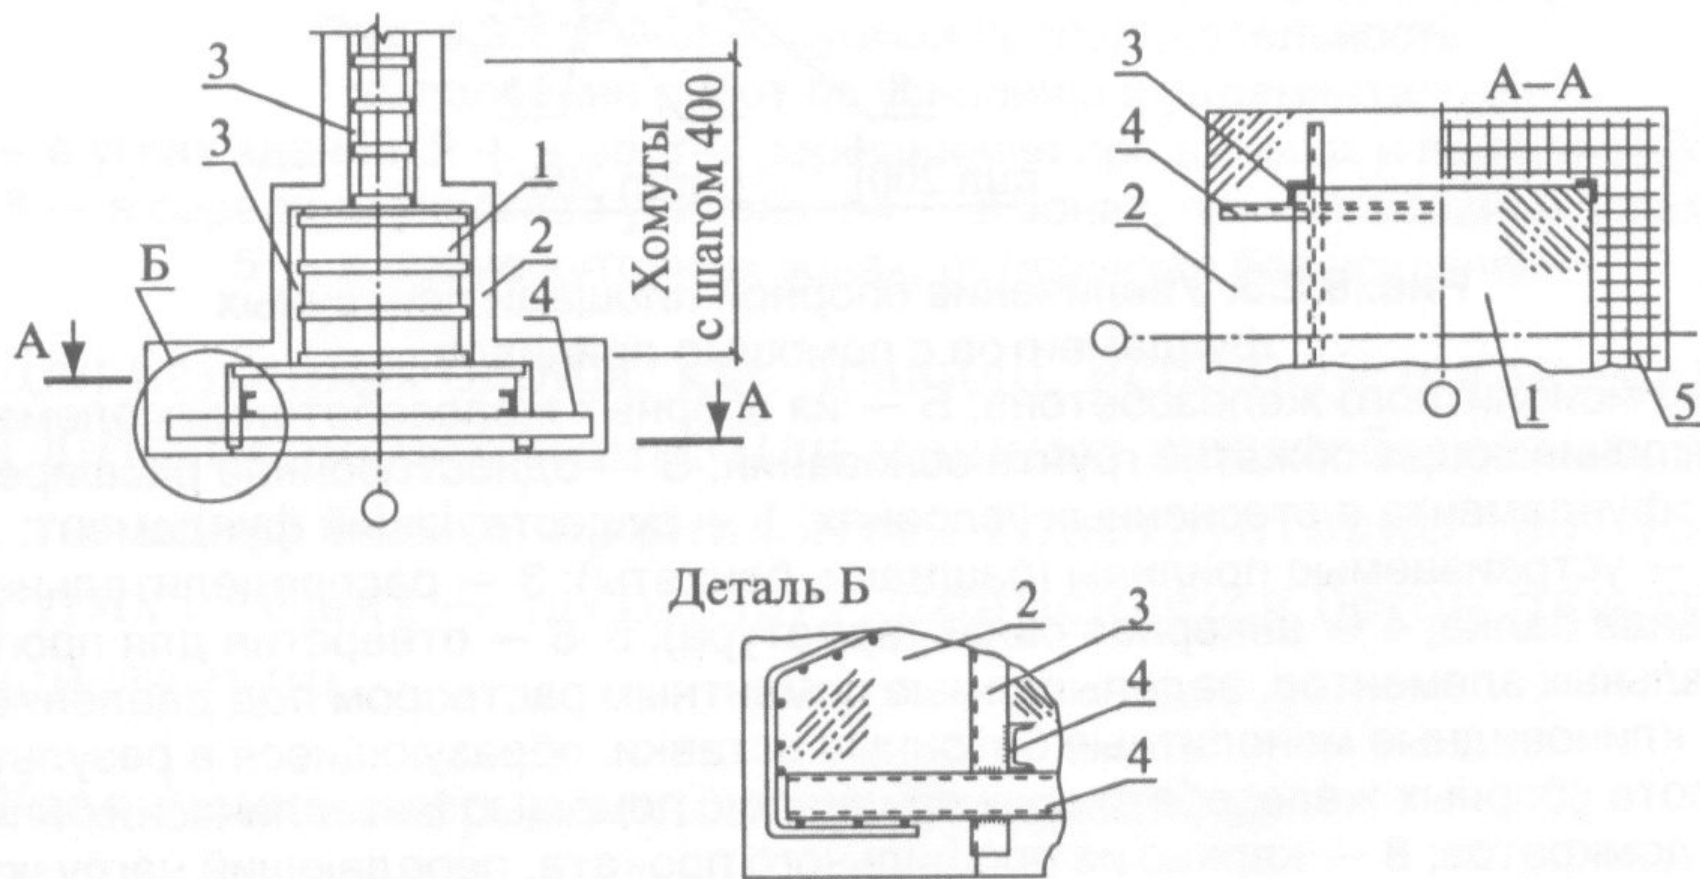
Усиление отдельно стоящих опор под колонны и столбы:
